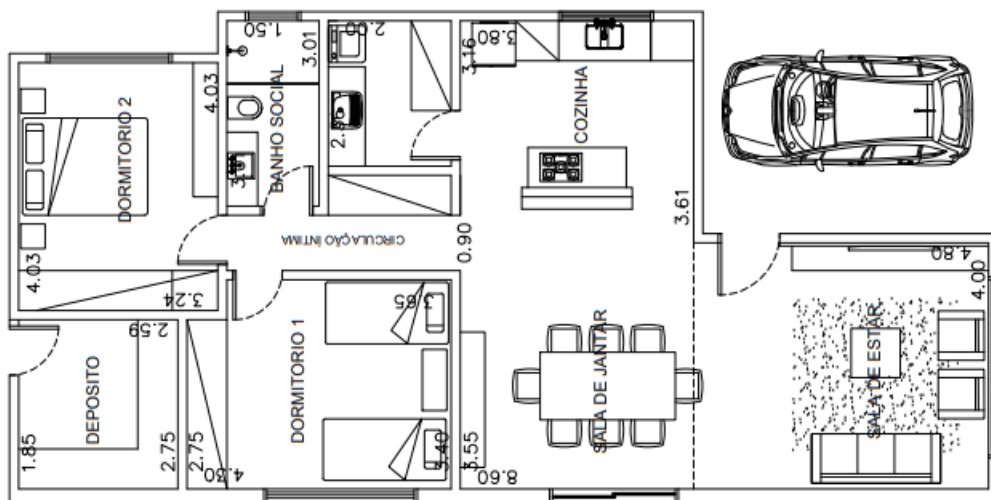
Planta baixa ( Elaborada por alunos. )
